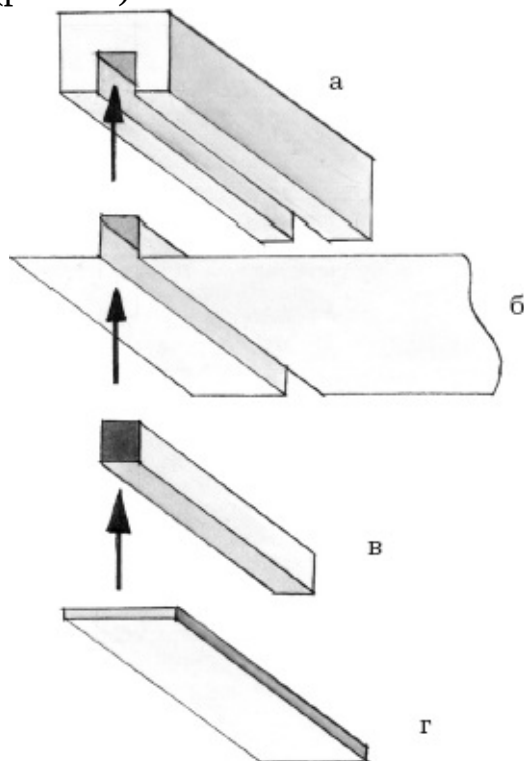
Устройство потолка кулачкового крепления: а – крепежный профиль; б – полотно; в – фиксирующий клин; г – багет
